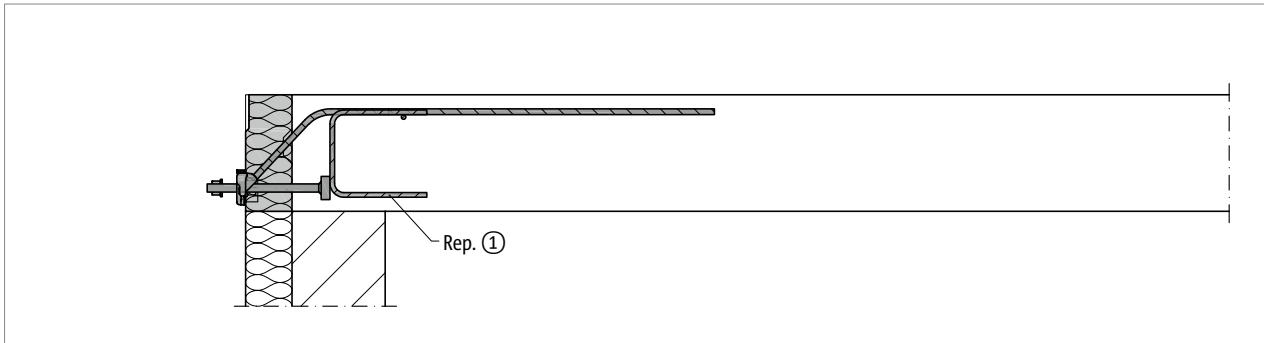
Schöck Isokorb® T type SQ : renforcement sur site, coupe
